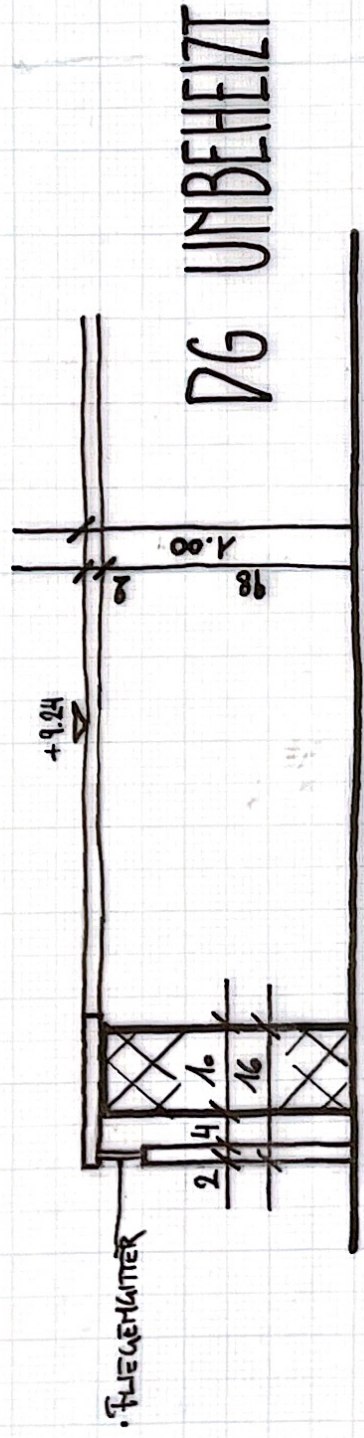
KONSTRUKTIVE GEDÄTKE
